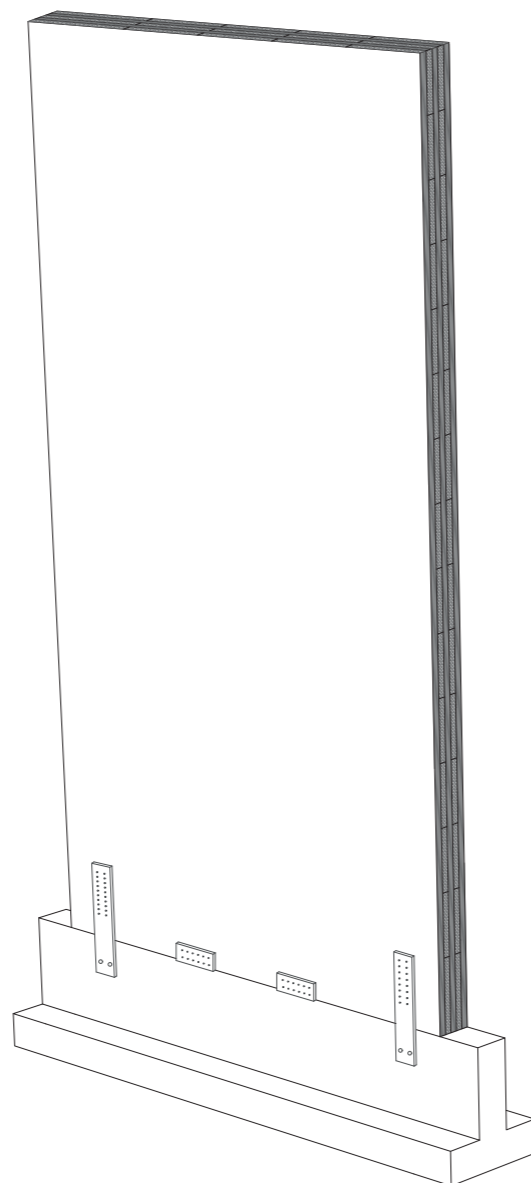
\_Rappresentazione tridimensionale del sistema di fondazione di un setto
